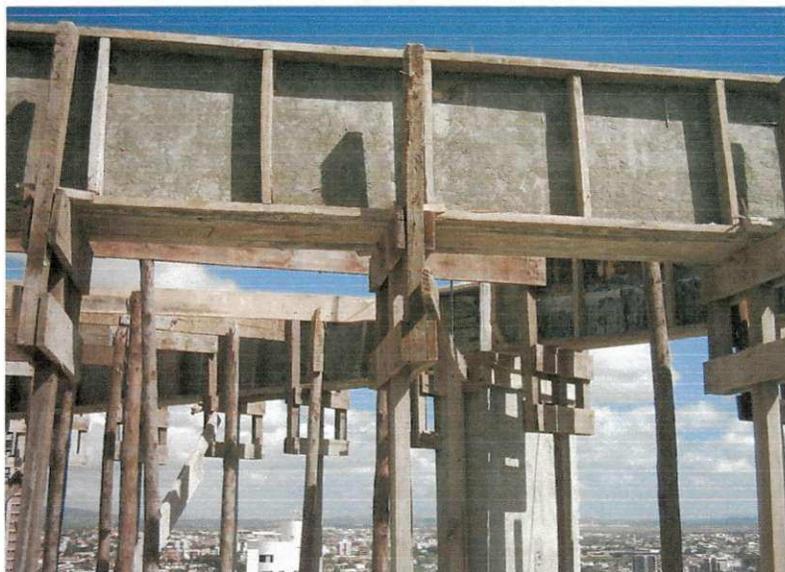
(A) os espaçadores nas vigas e lajes
